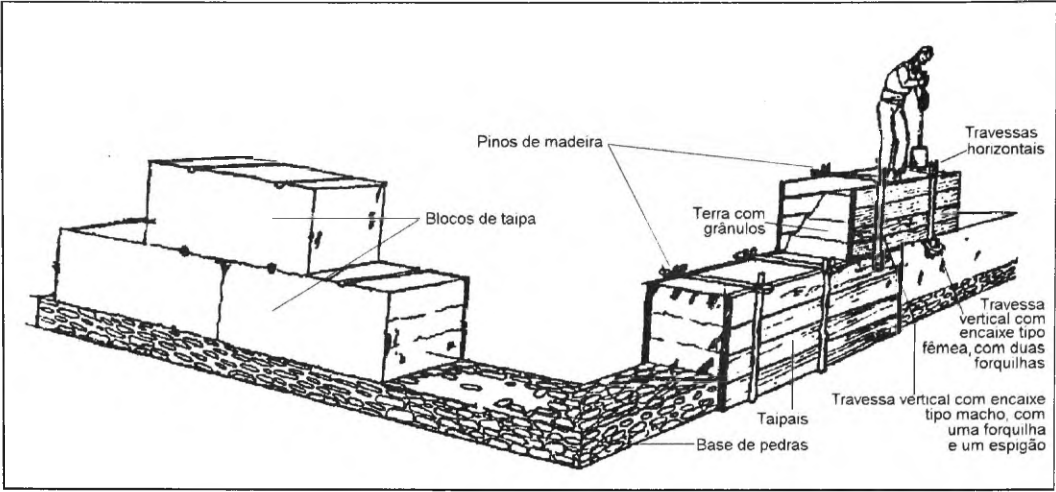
Construção de um muro em taipa de pilão (Blumme, 1985).
